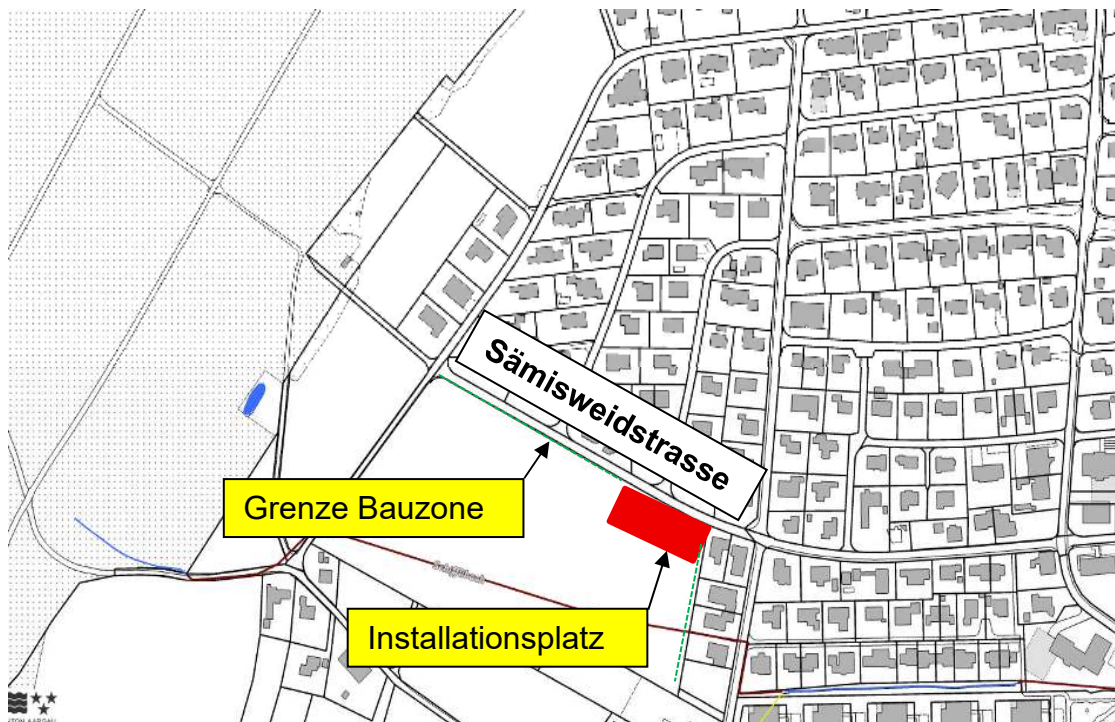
; Projektperimeter mit Lage Installationsplatz (rot) und Bauzonengrenze (grün)
